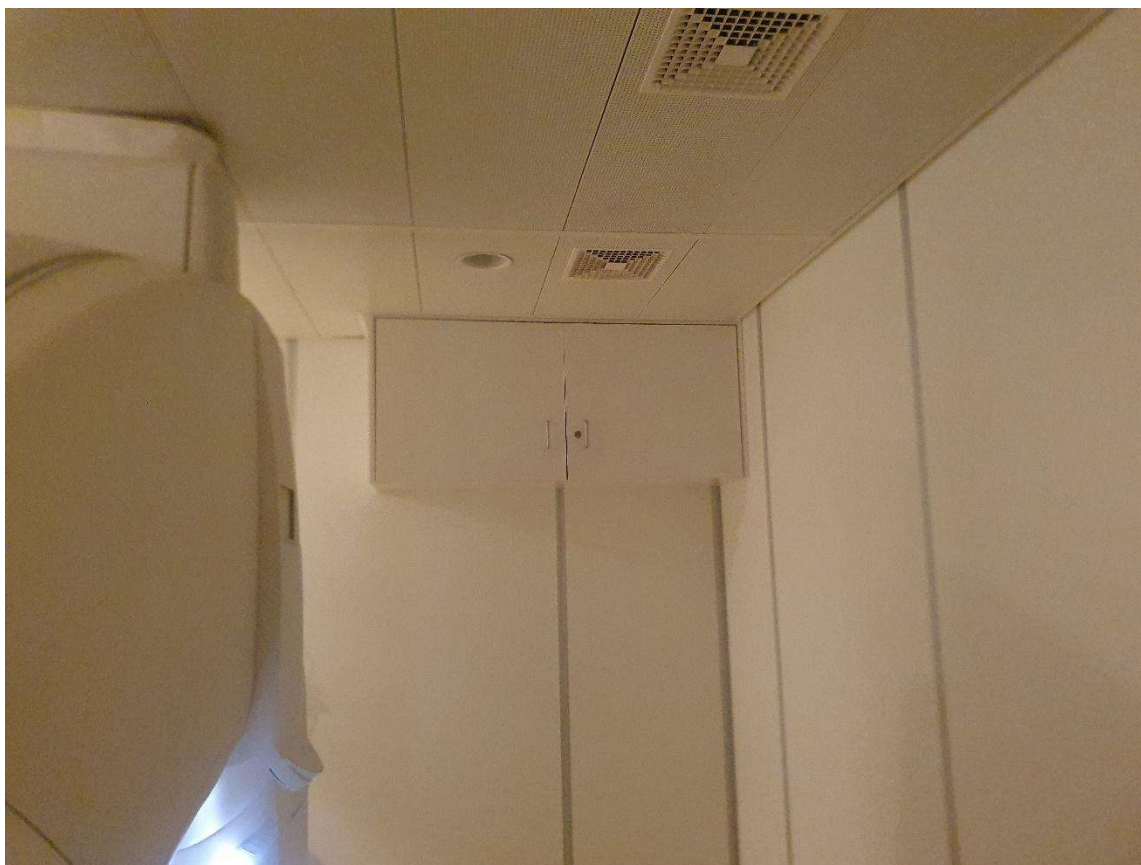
Stralcio porzione di controsoffitto e vano guide d'onda.
